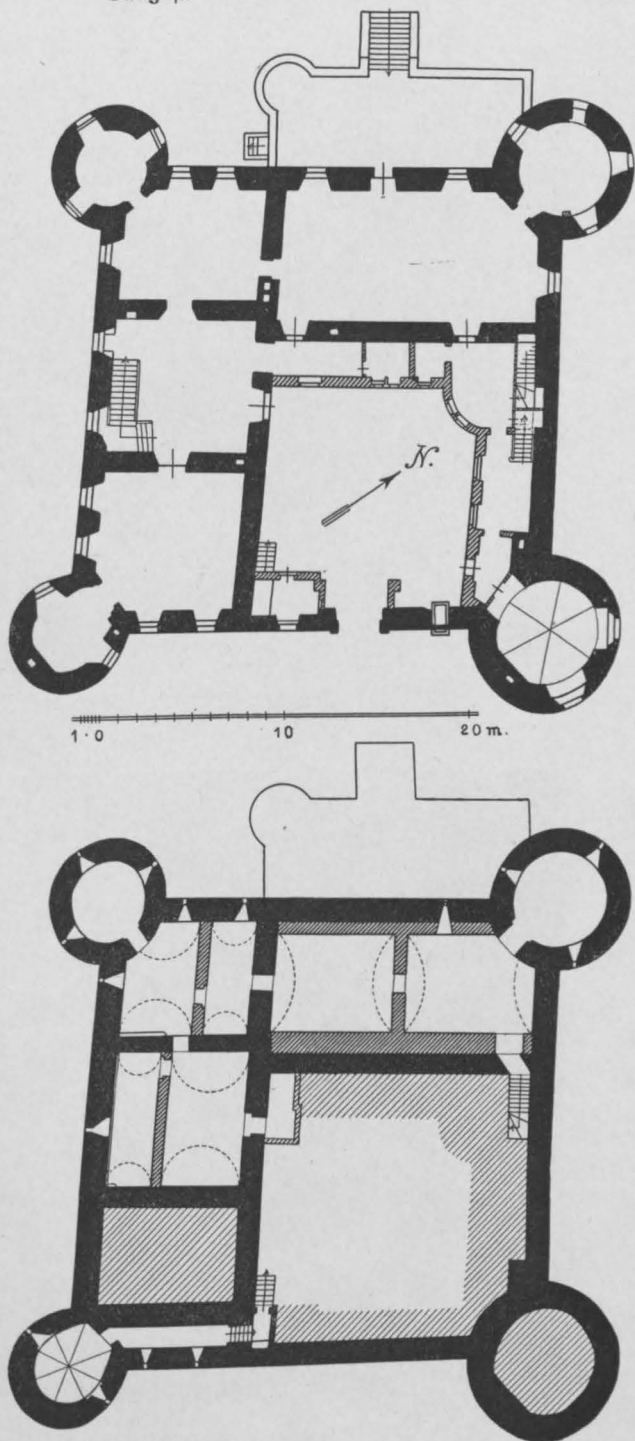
Sallgast. Grundrisse des Schlosses.
